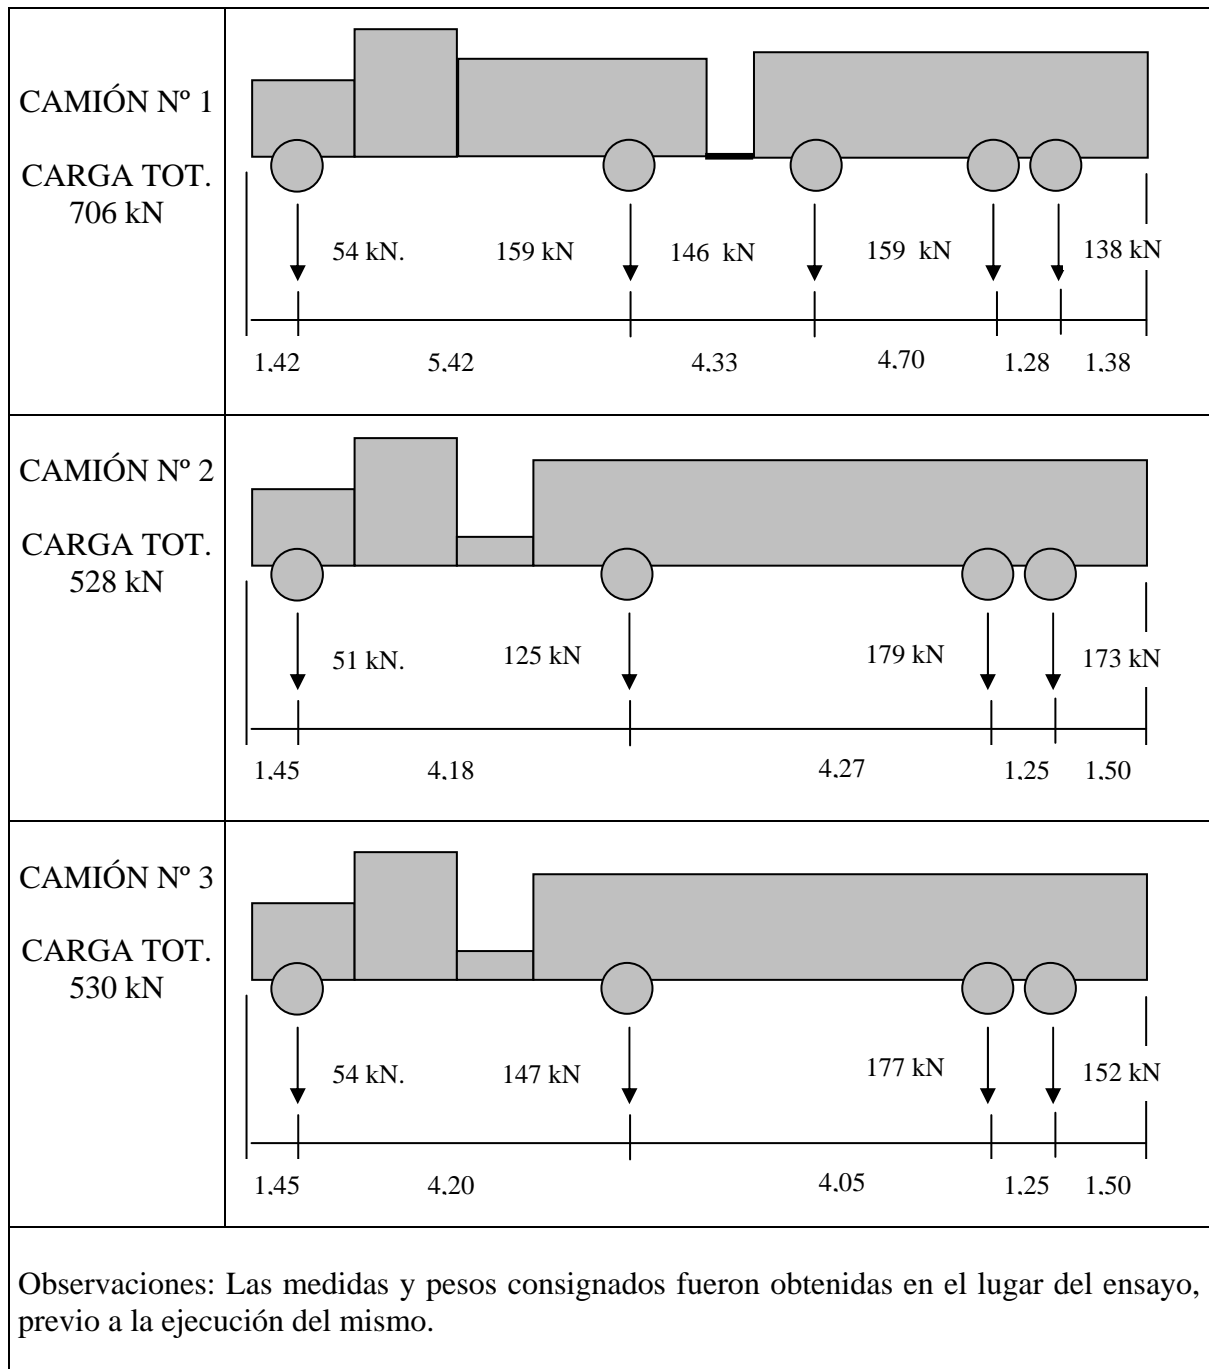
Esquema de las cargas empleadas en el ensayo.
